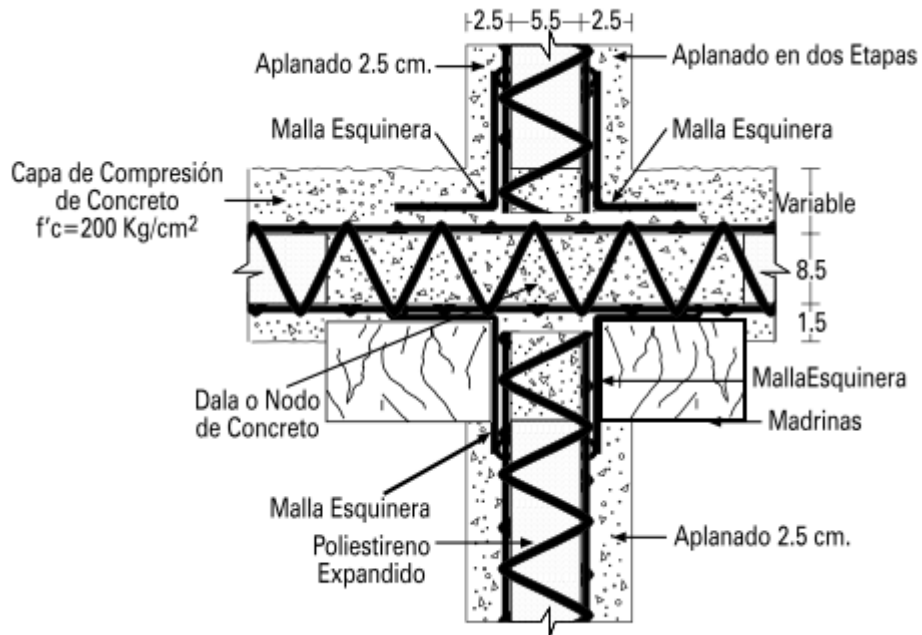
Unión de losa con muros (Planta baja y primer nivel).
